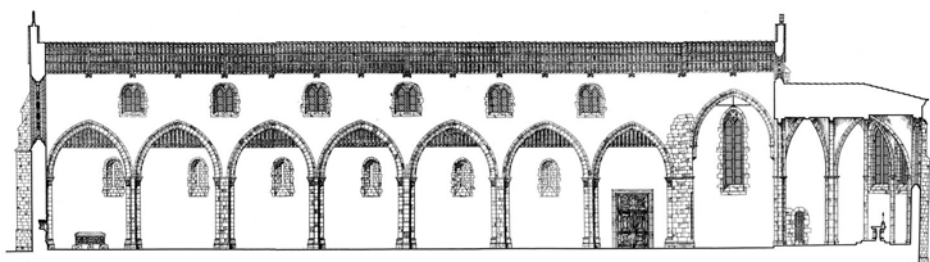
Santa Clara de Santarém, corte longitudinal (DGEMN).
